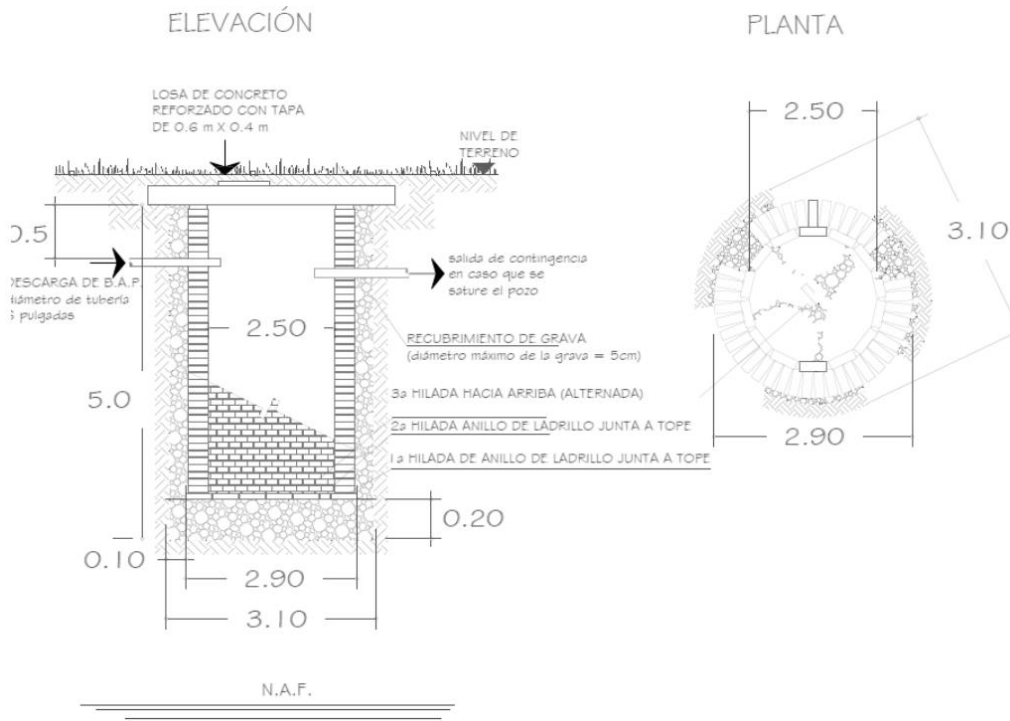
Pozo de absorción/infiltración Construido in-situ⁴⁶
